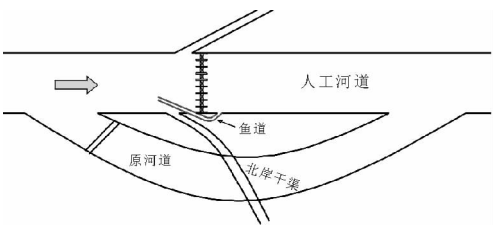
冲沙闸和北岸干渠之间布置鱼道方案平面布置示意
